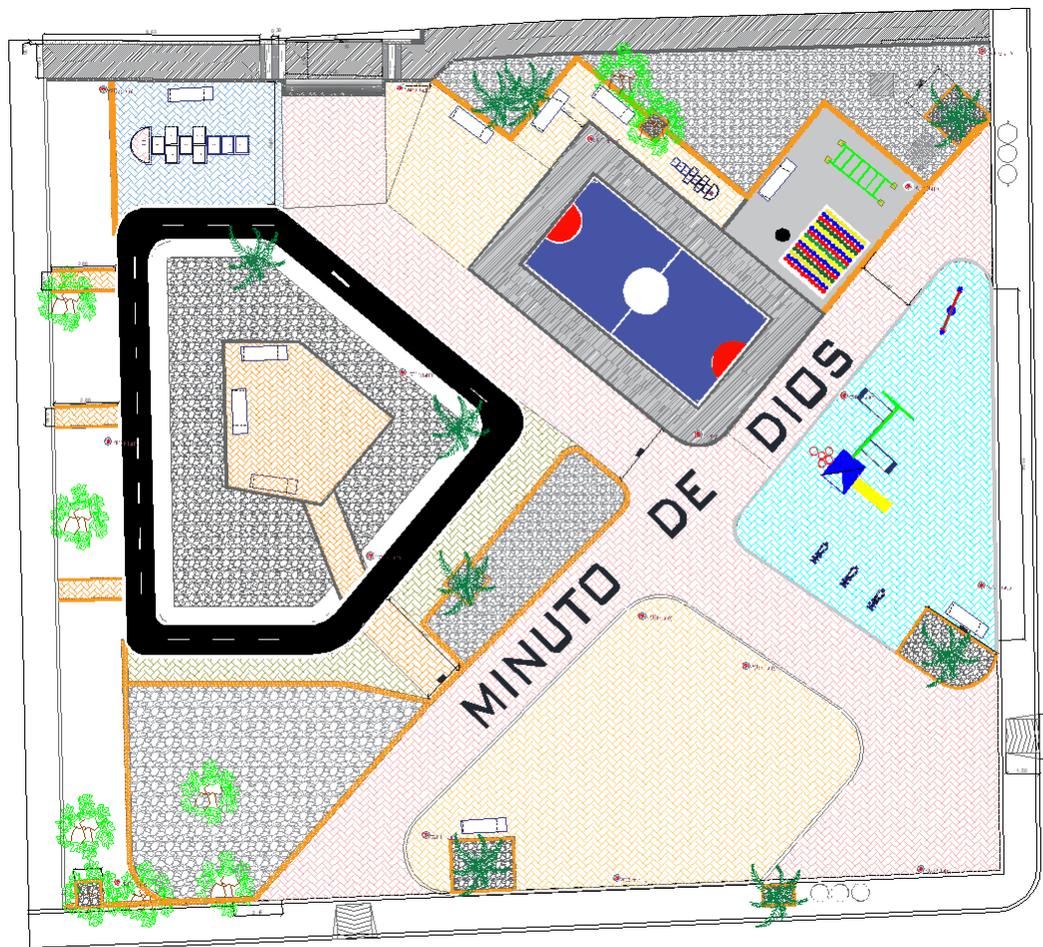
Plano arquitectónico – planta general parque minuto de Dios.
